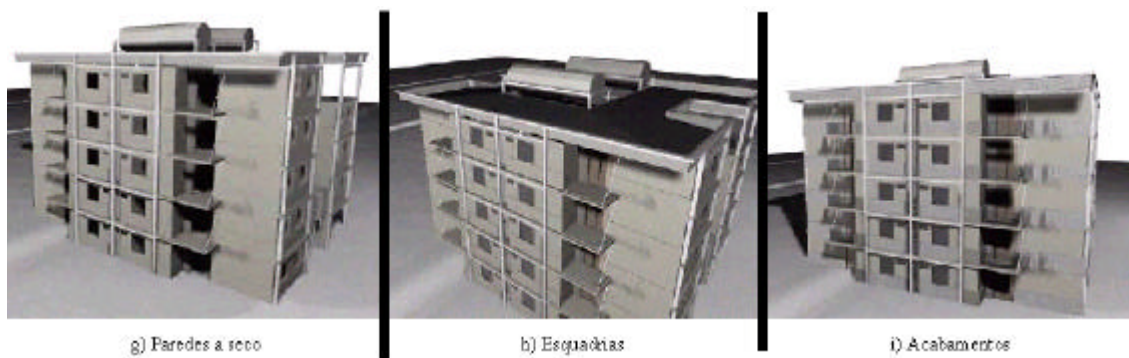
Seqüência de montagem execução da concepção arquitetônica proposta.
